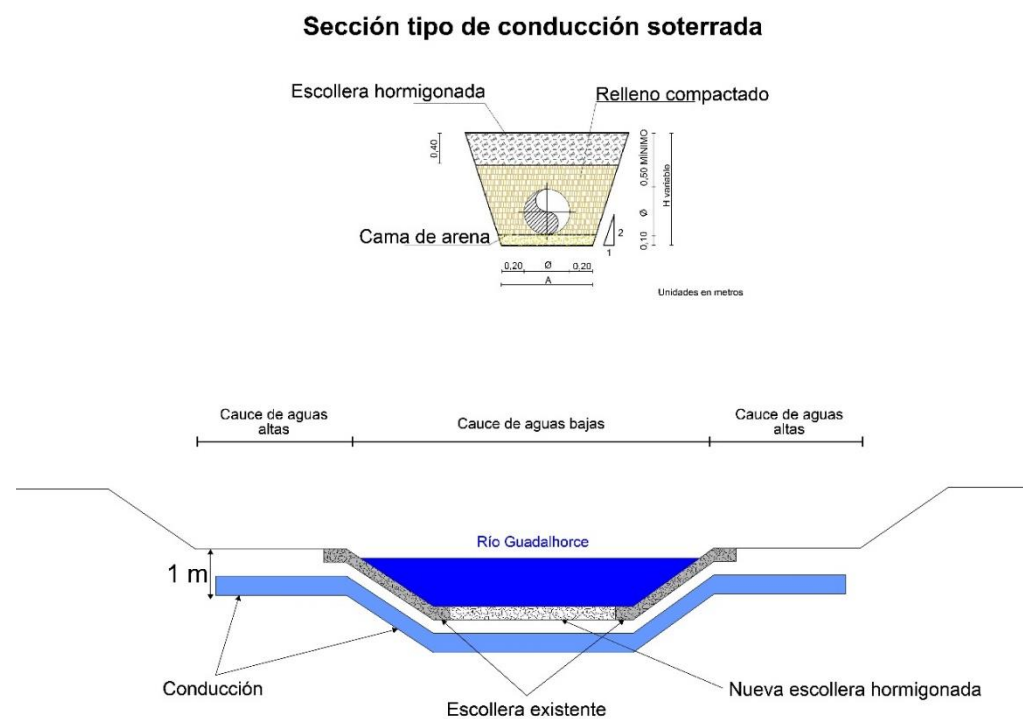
Croquis de la tubería por debajo del cauce del río Guadalhorce
